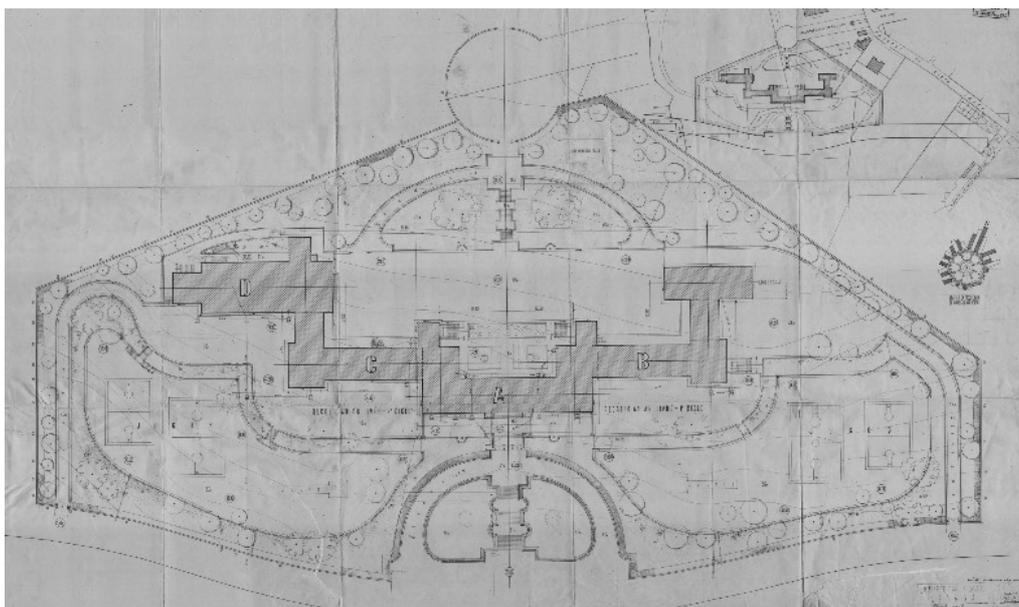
Planta de cobertura - Projeto do Arquitecto José Costa e Silva
